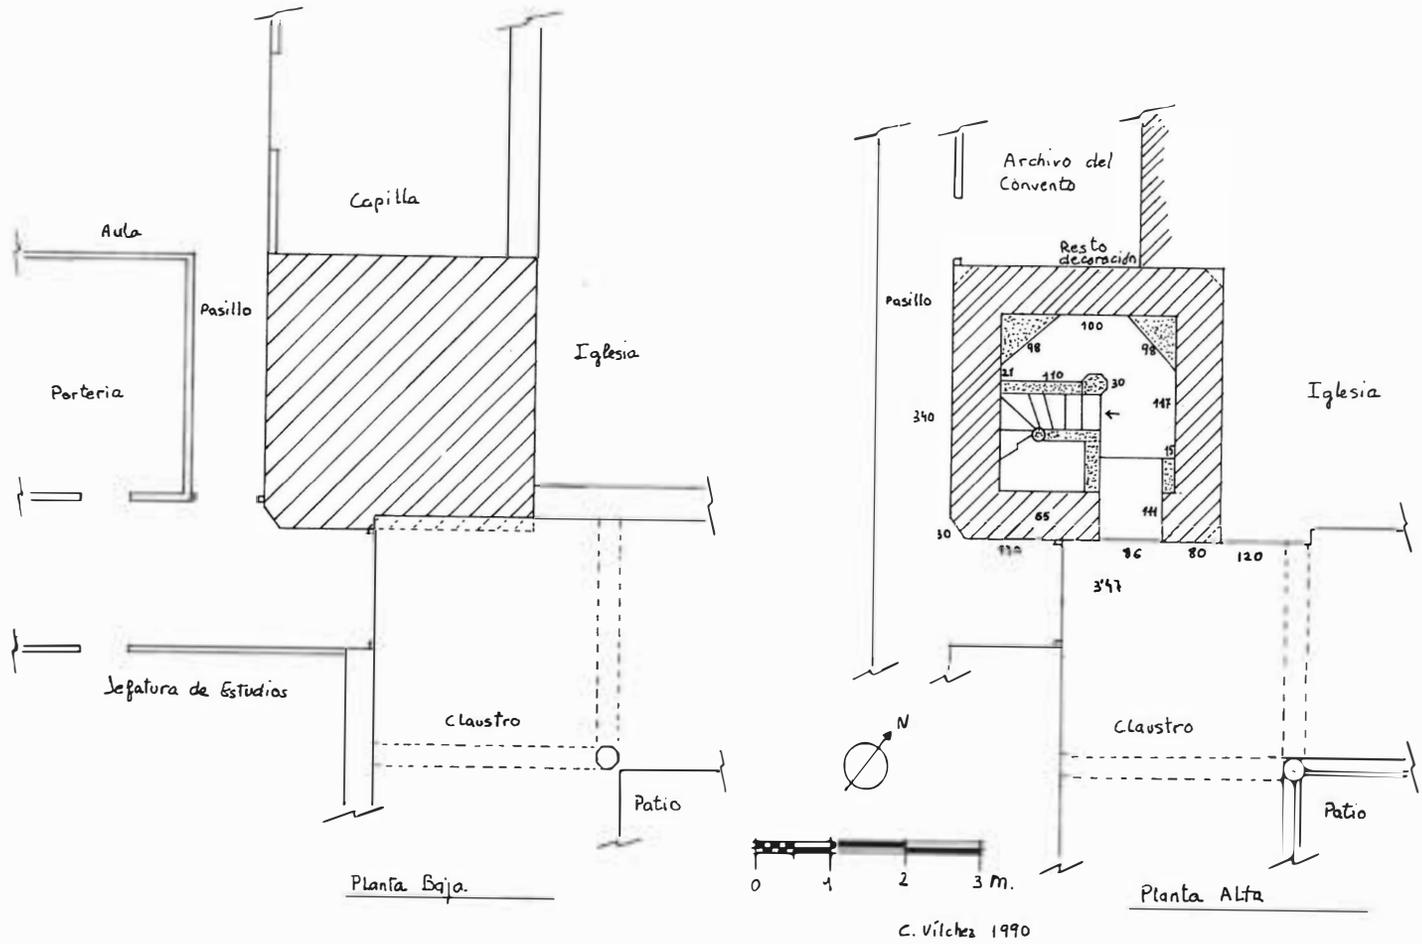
Convento de San Francisco. Planta baja y planta alta. (Dibujo C. Vilchez).
